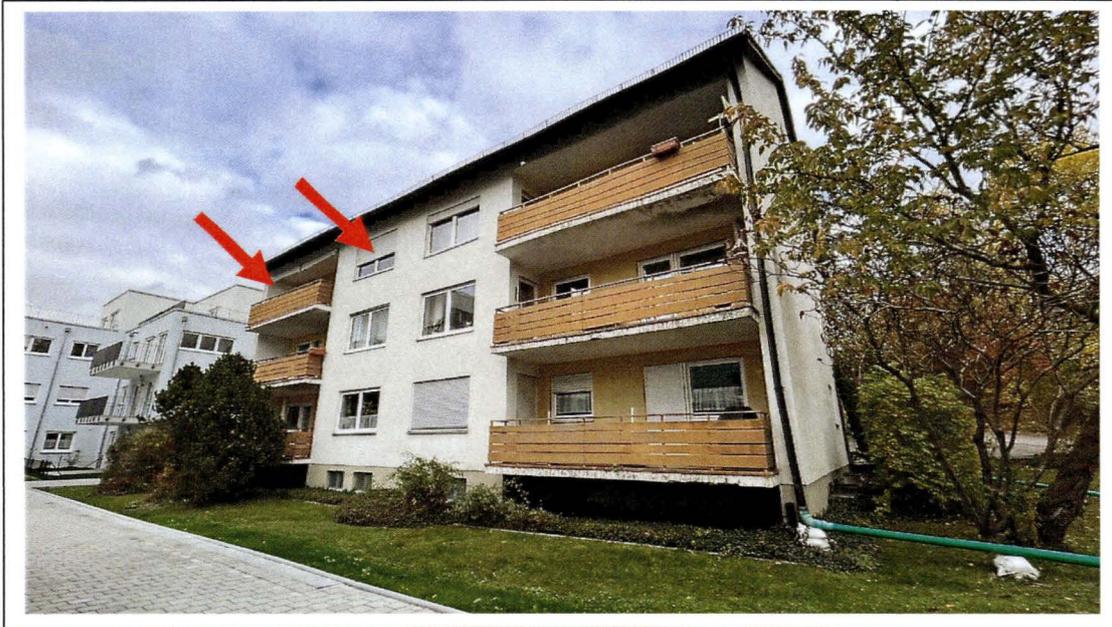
Wohnhaus Tuchinger Straße 35 - Ansicht von Südwesten
